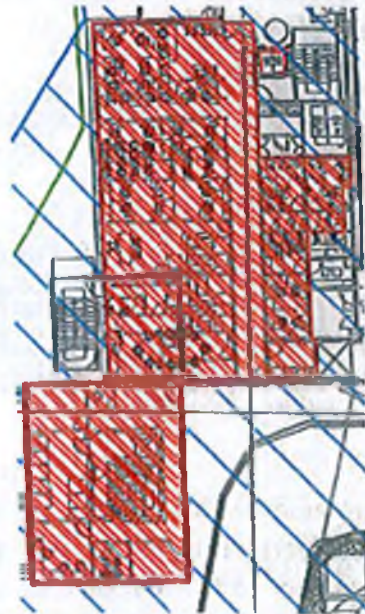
Planta Segundo Piso, Áreas de Aerocivil
